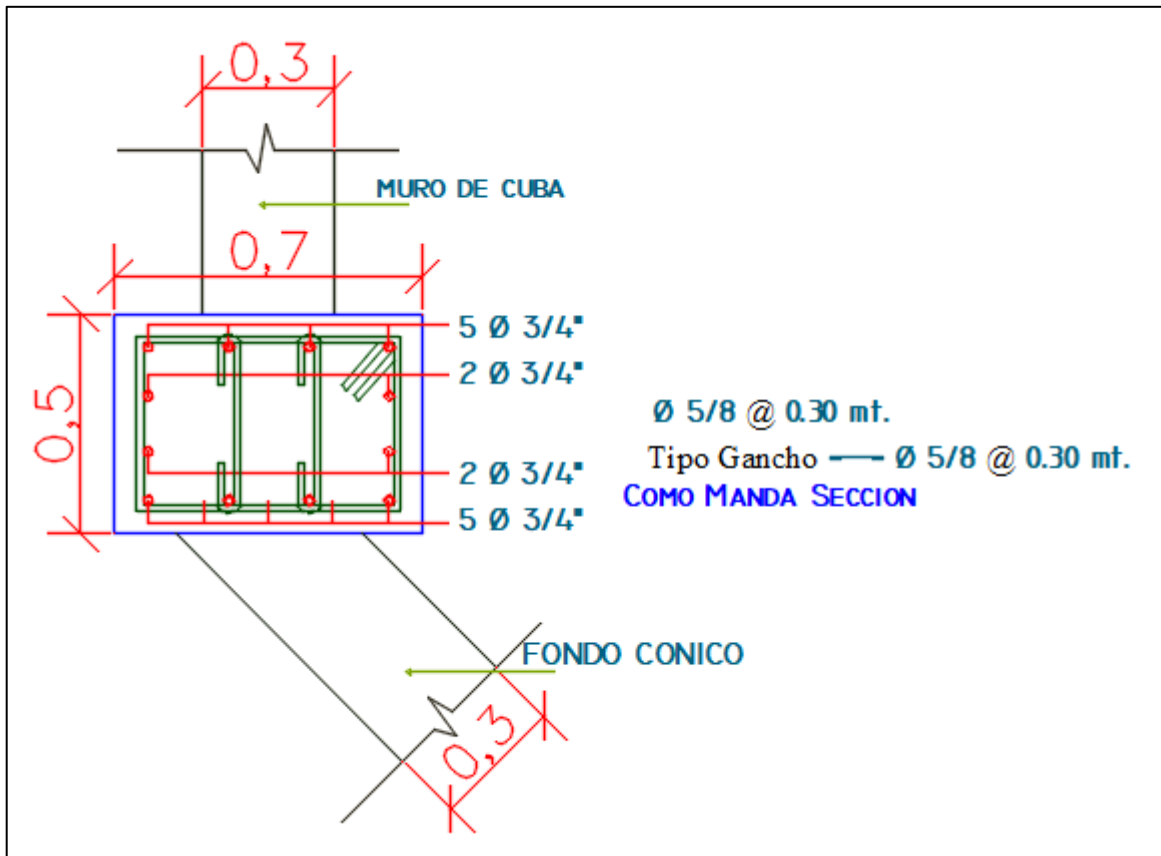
Plano de detalle de distribución de acero en la viga inferior de la cuba.
